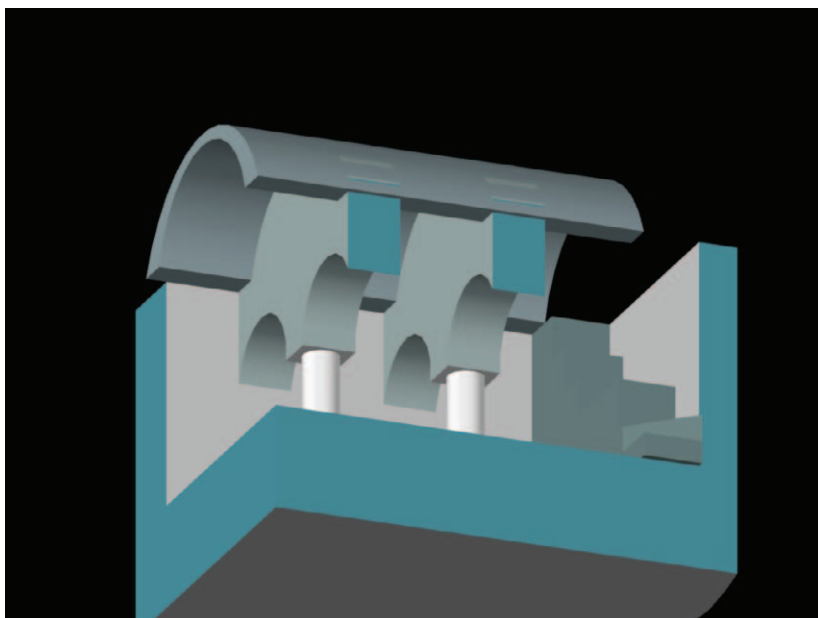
مسقط أفقي لخواب درب المغربة (رسم الباحث)
